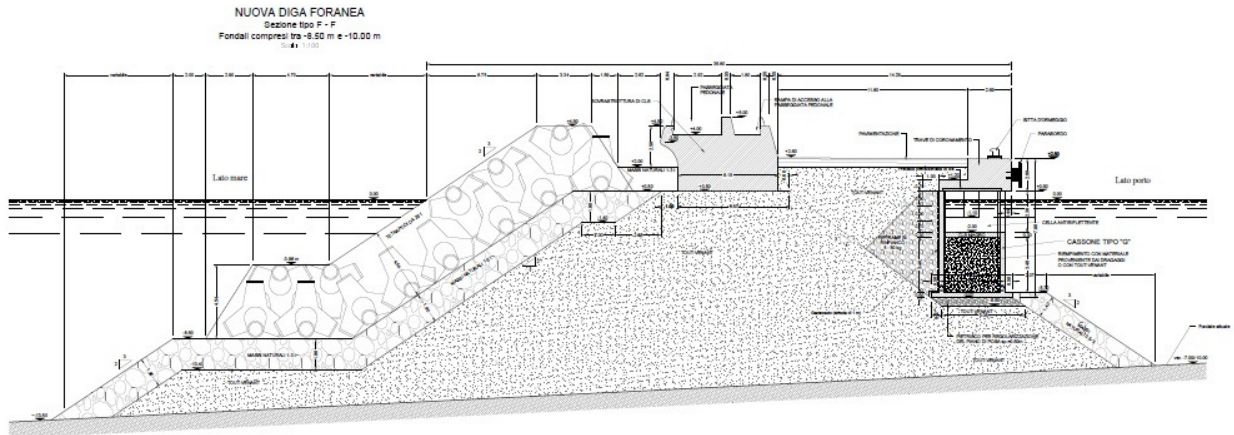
Sezione tipo della diga foranea per fondali compresi tra -8,50 m e -10,00 m
